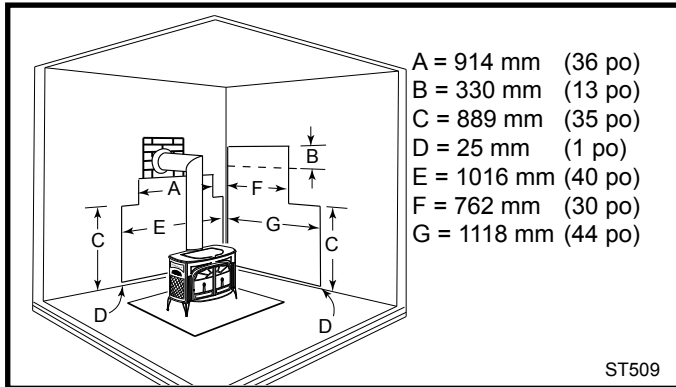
Installations parallèles avec passe-plats de mur arrière, deux protecteurs muraux. Espaces libres réduits pour murs arrière et latéraux. Les protecteurs muraux peuvent se rejoindre dans un angle, au besoin. La protection pour le connecteur est centrée derrière le connecteur. Le passe-plats de mur doit être conforme aux codes.
